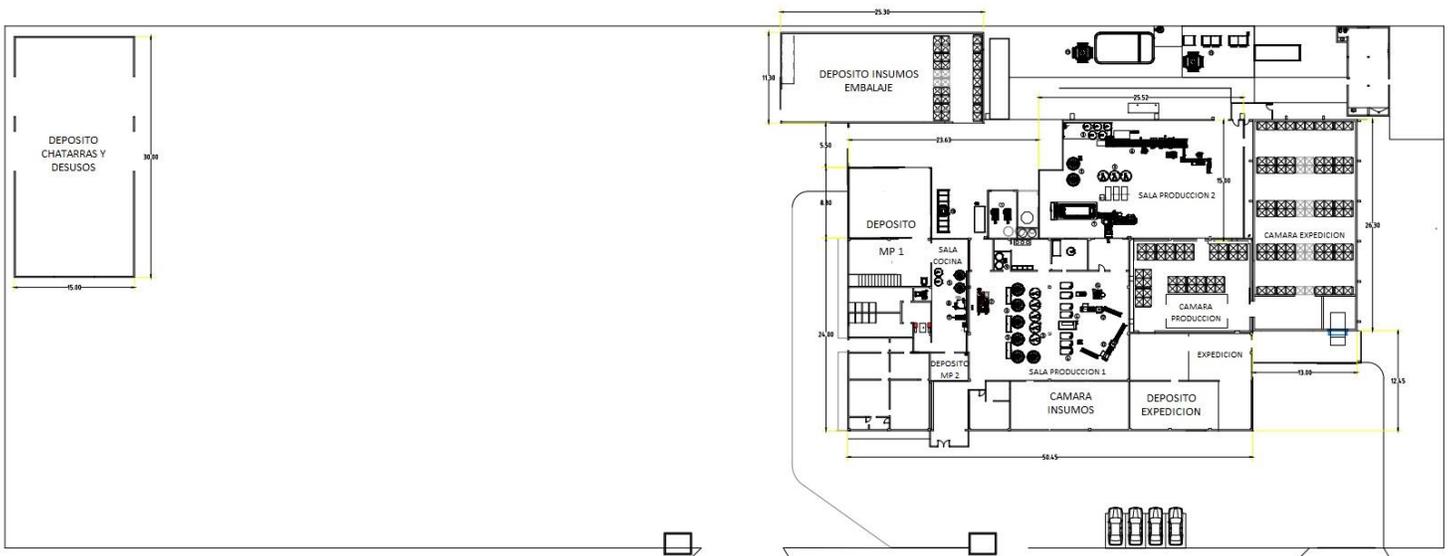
Layout de la planta industrial de Veneto S.A. Fuente: Veneto S.A.
